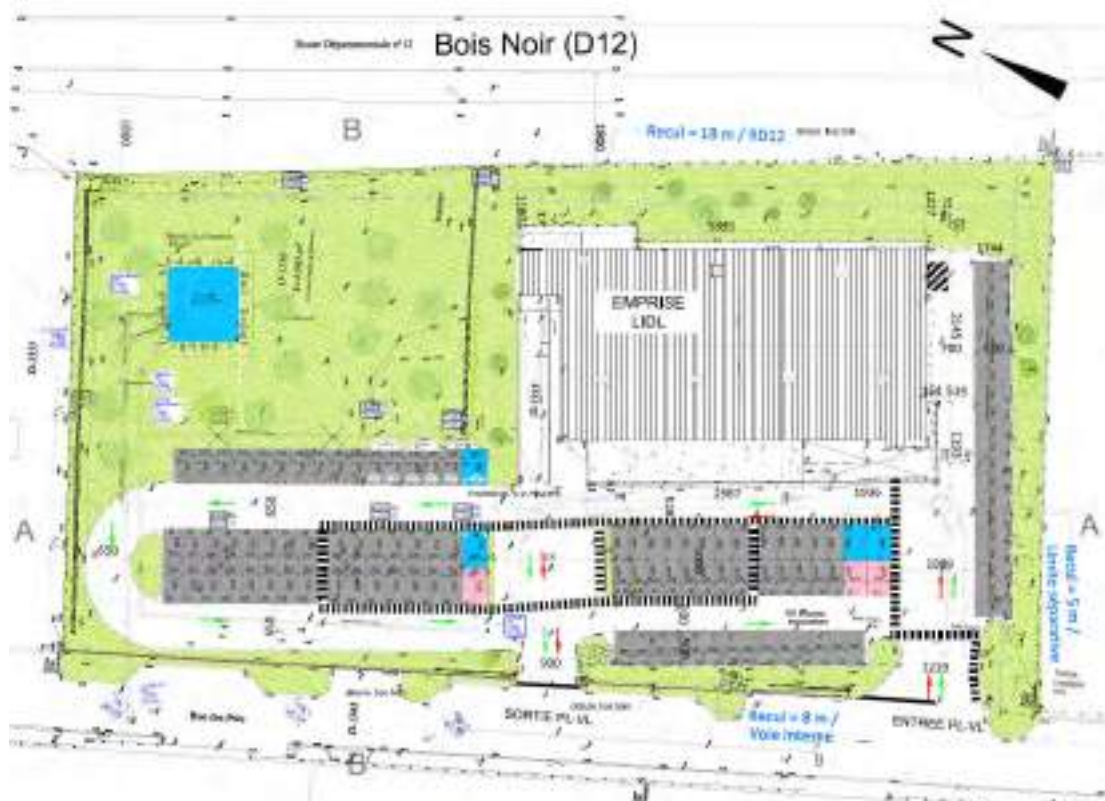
Extrait du plan de masse du projet (existant + extension)
